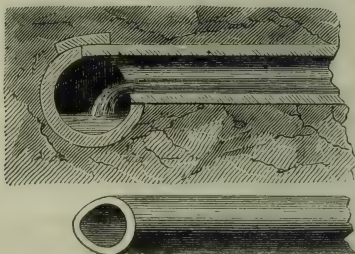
Plan et coupe du raccordement de deux tuyaux.
